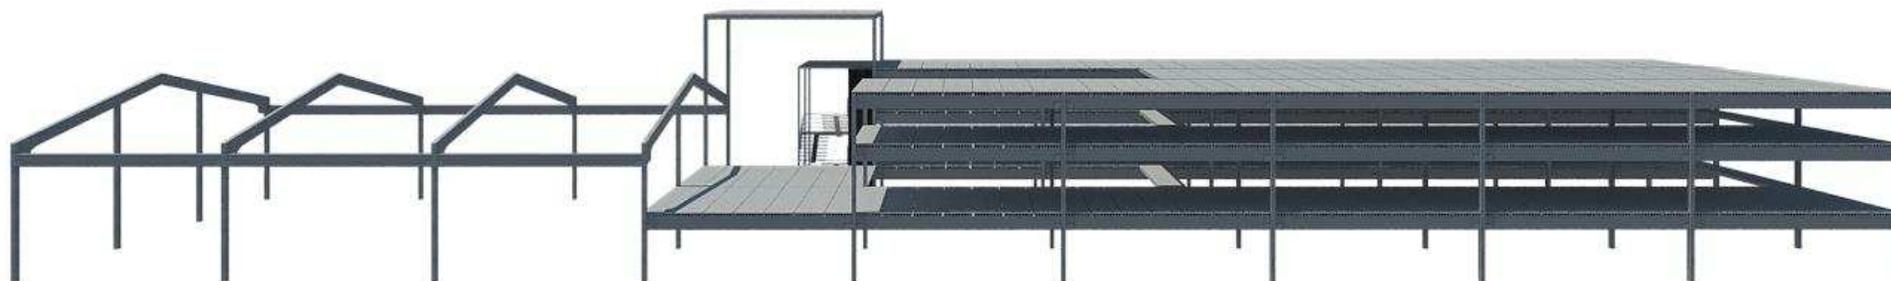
Visão isolada do sistema estrutural. Fonte: A autora
